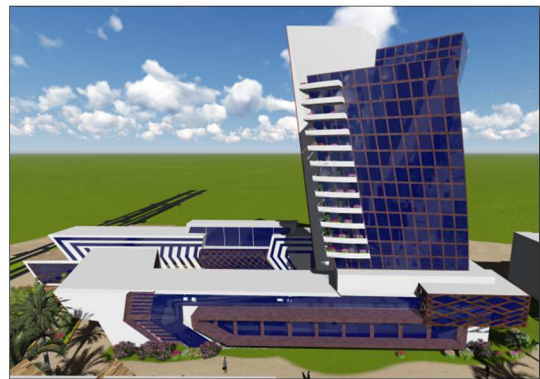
Vue sur la façade Sud du projet (Sur Tripoli)
